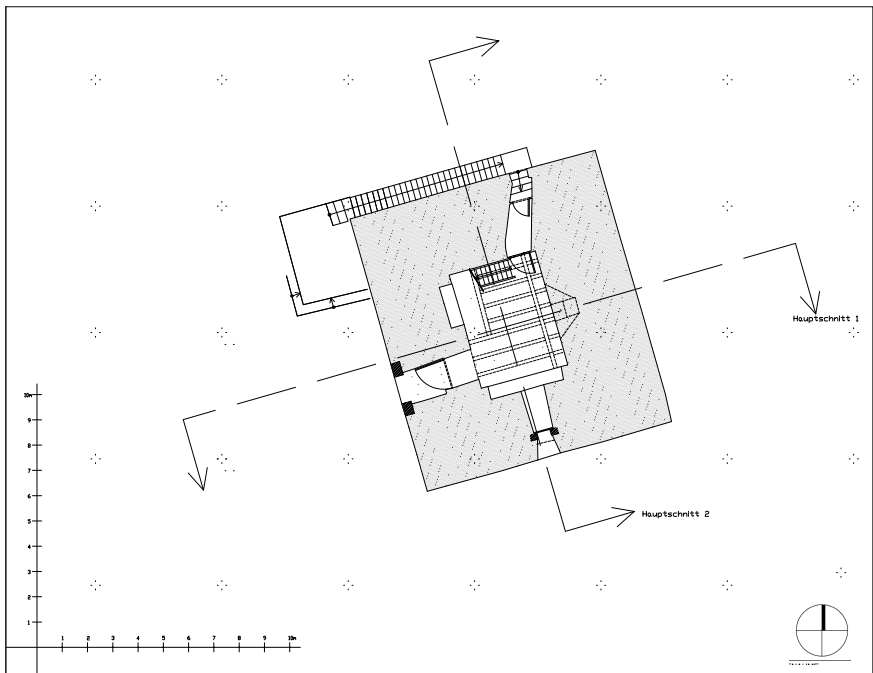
Grundriss des ersten Obergeschosses (Eingangsgeschoss) (Zeichnung: Armin Seidel, Ostfildern).
